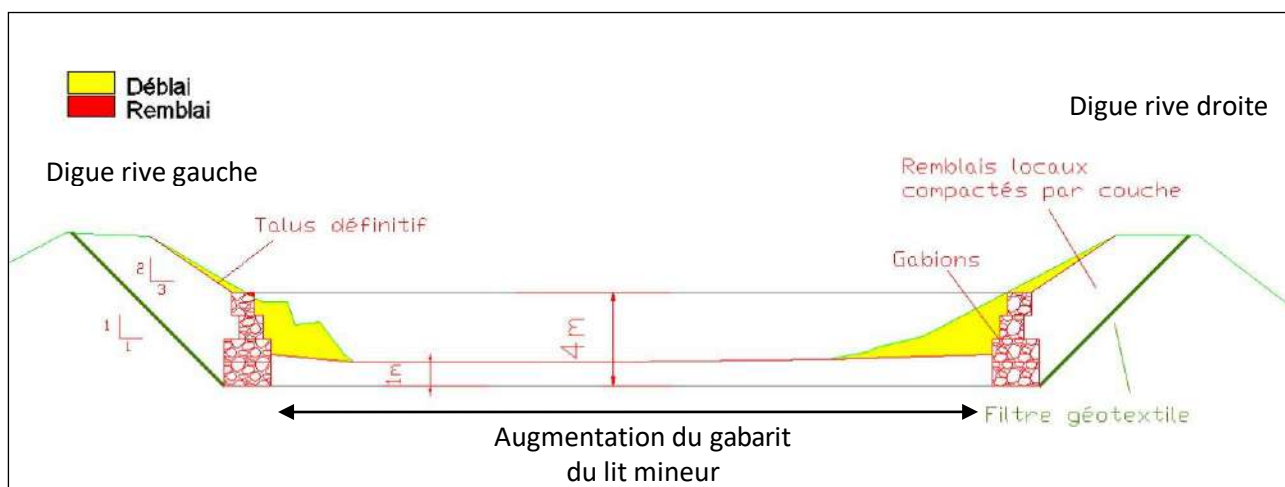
Coupe type de la protection des digues dans la traversée de Bollène
